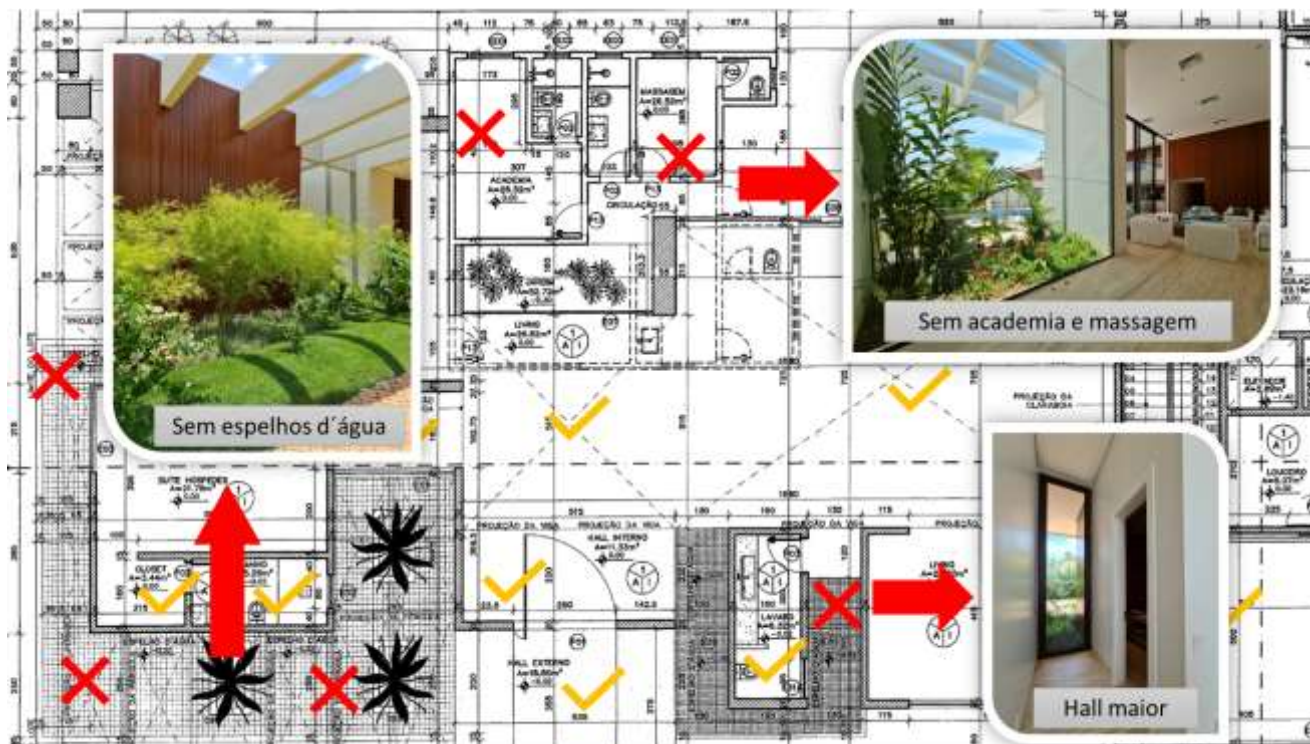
Divergências do Projeto Aprovado X Executado – Térreo (Parte 1)
